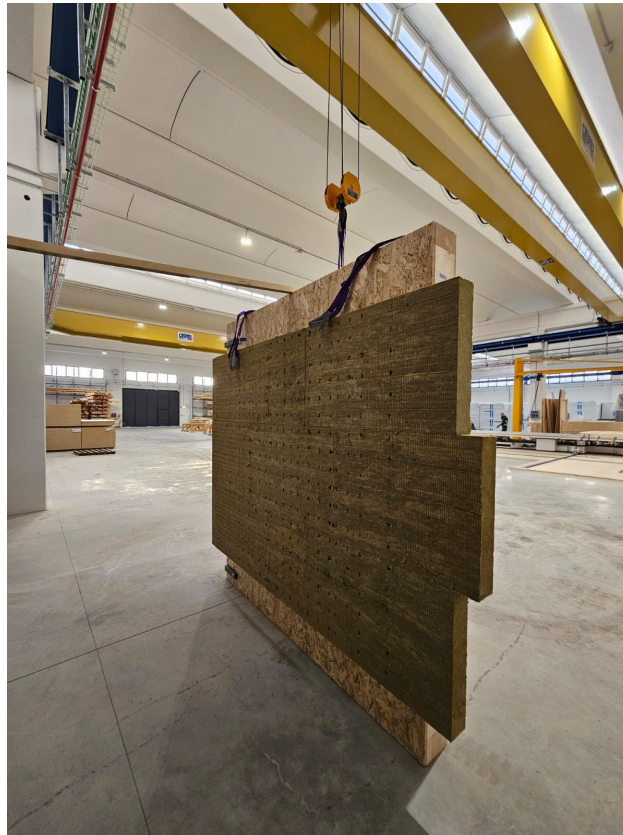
Una delle pareti del blocco tridimensionale, con cappotto installato
